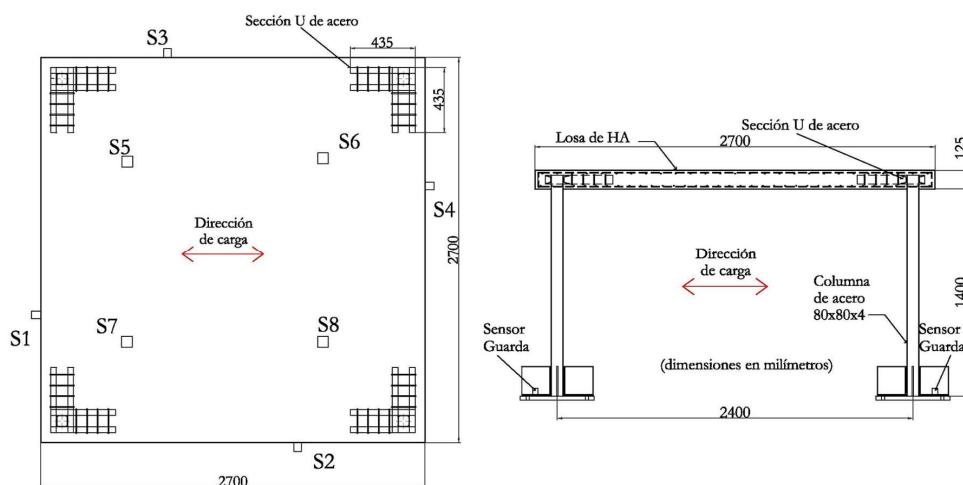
Modelo de ensayo de la losa con pilares metálicos. Izqda.: Planta. Dcha.: Alzado. Medidas en mm.
